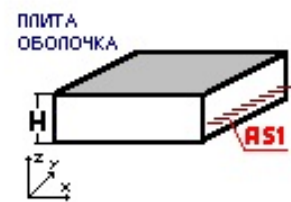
Нижняя грань, площадь арматуры вдоль оси X
